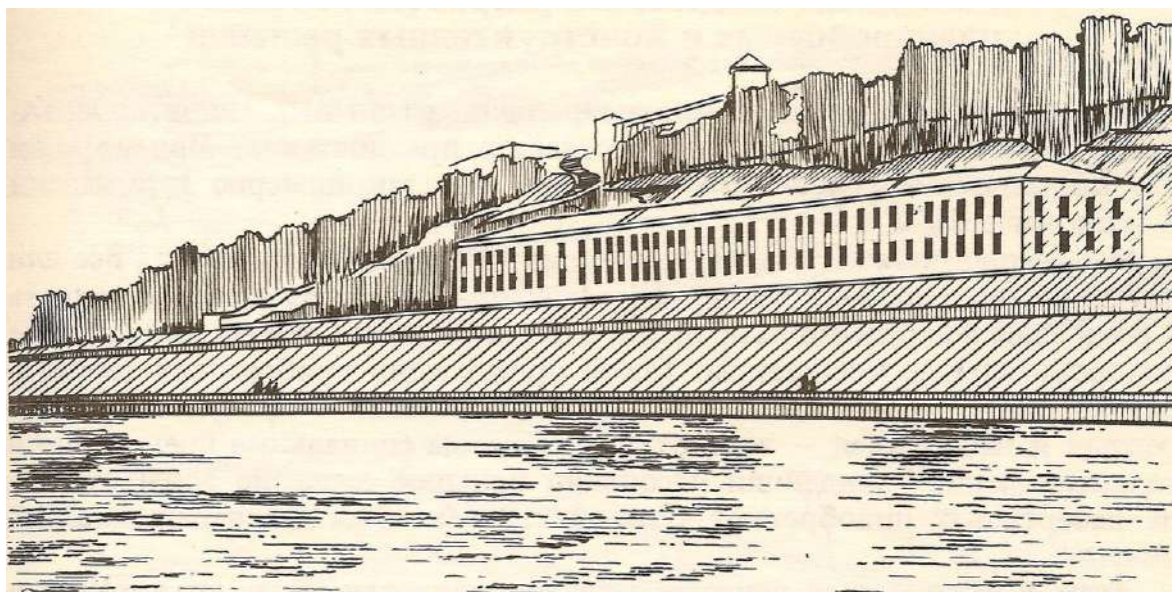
Схема берегоукрепления Нижне-Волжской набережной [1].
